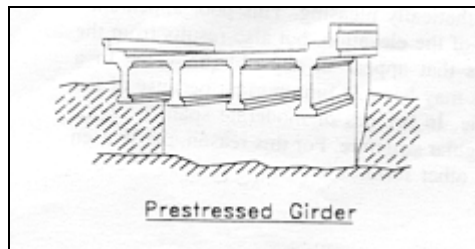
Puente de Vigas I Prefabricadas de Concreto.
